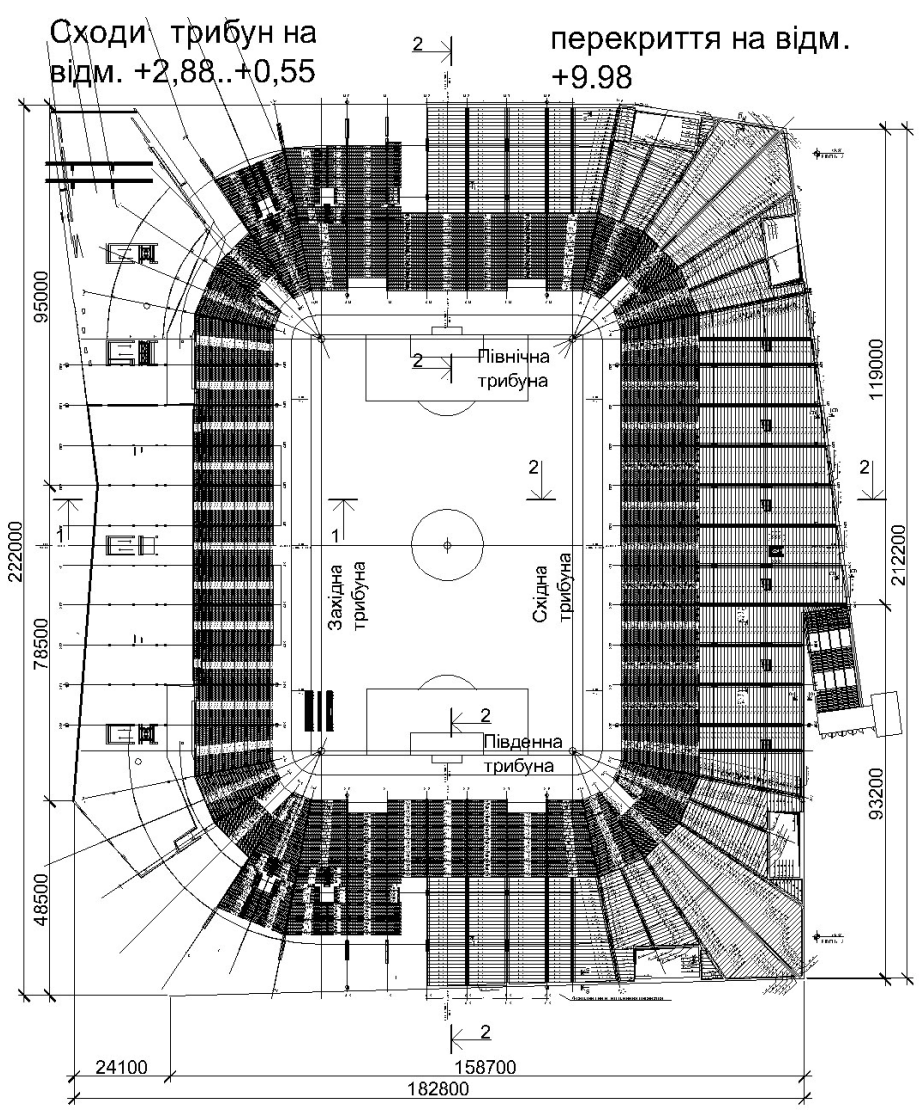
Розміщення у плані монтажних плит із сталевого хвилястого настилу
